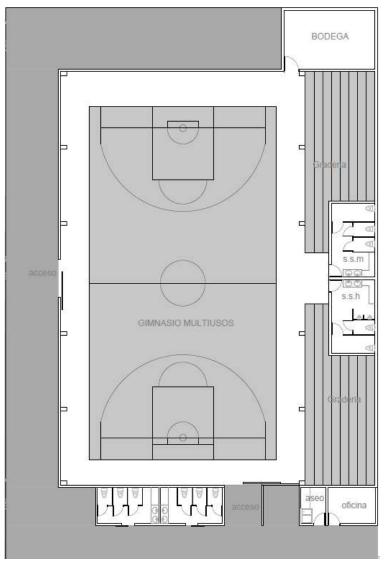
Plano distribución Arquitectónica Gimnasio. Elaboración propia
